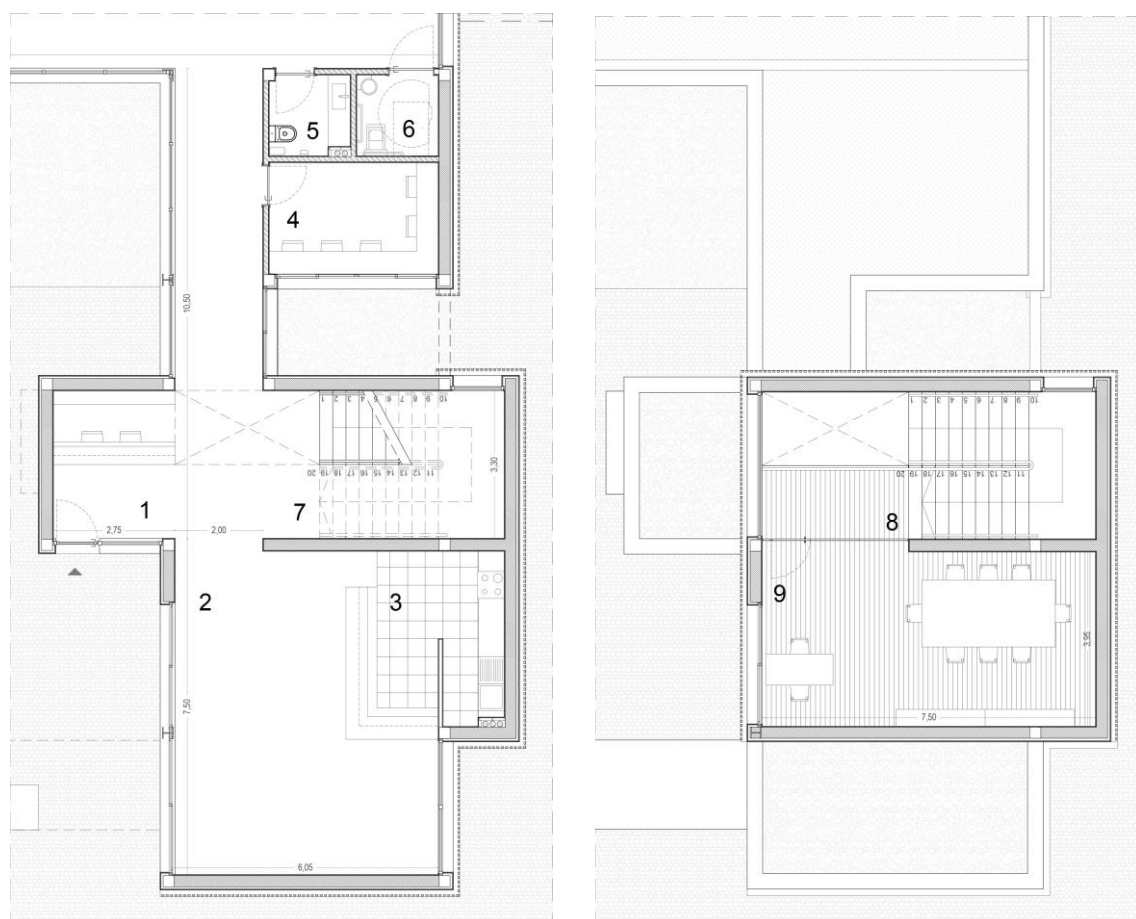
Planta pormenorizada da zona social, respetivamente piso 1 e 0.
